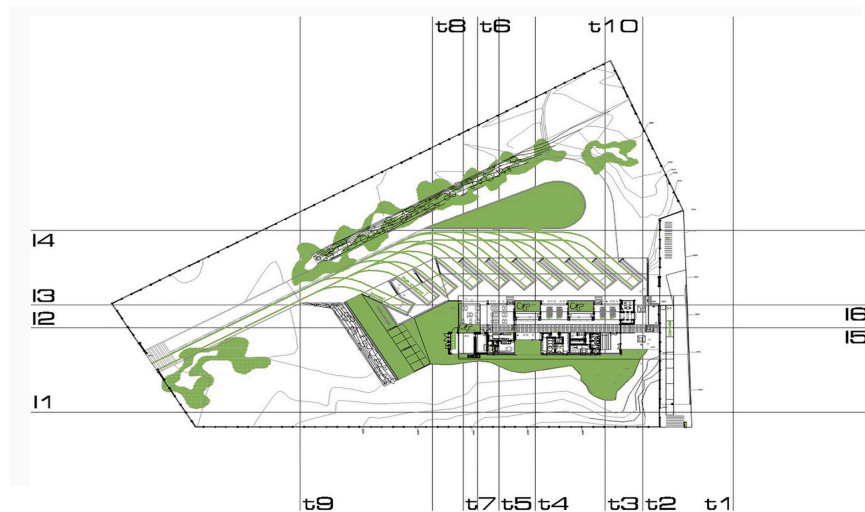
Ejes Urbanos, Plan Urbano Fuente: Ismo Arquitectura, Málaga España
